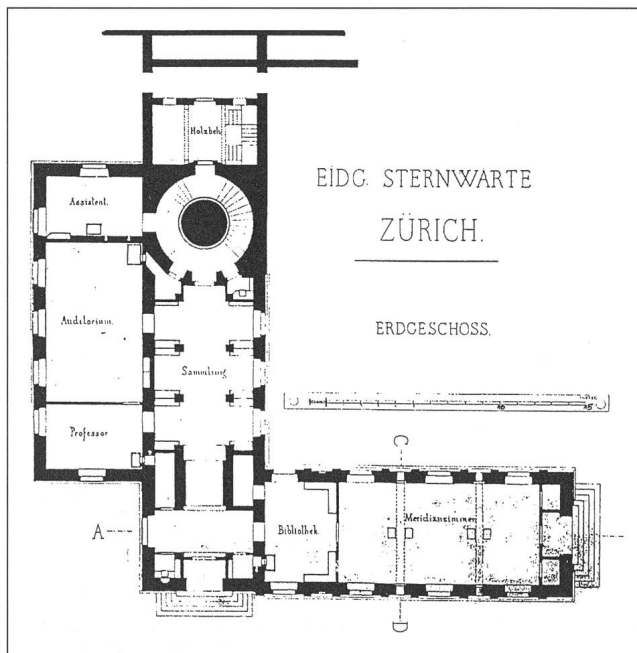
; Grundriss des Erdgeschosses.
